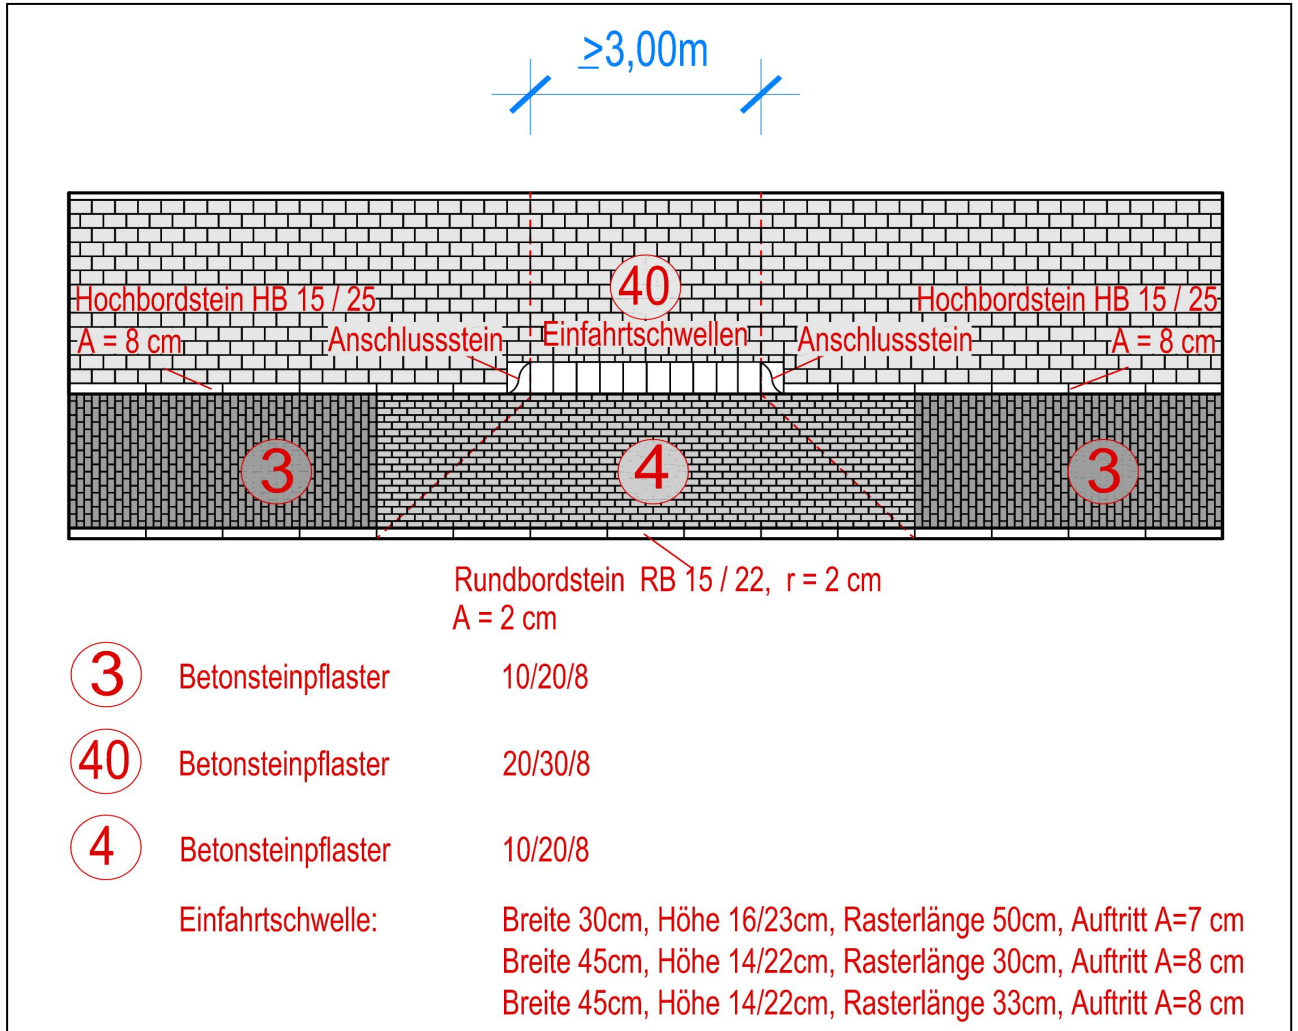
Grundstückszufahrt mit Parkstreifen (Regellösung)
